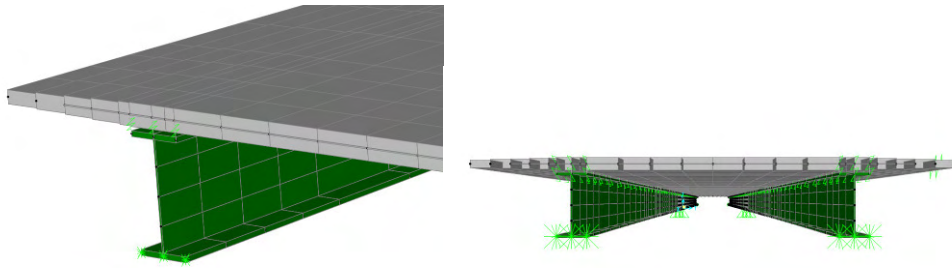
Detalhe de ligação viga - laje e secção transversal.
